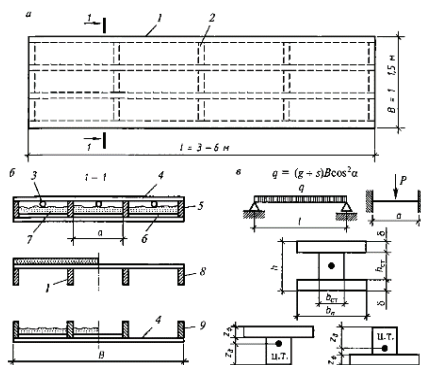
Клеефанерные ребристые плиты настилов: а – плита (вид сверху); б – сечения плит; в – расчетные схемы и сечения; 1, 2 – продольные и поперечные дощатые ребра; 3 – вентиляционные отверстия; 4 – строительная фанера; 5 – коробчатая плита с двумя обшивками; 6 – пароизоляция - ция; 7 – утеплитель; 8 – ребристая плита с верхней обшивкой; 9 – то же, с нижней обшивкой.
